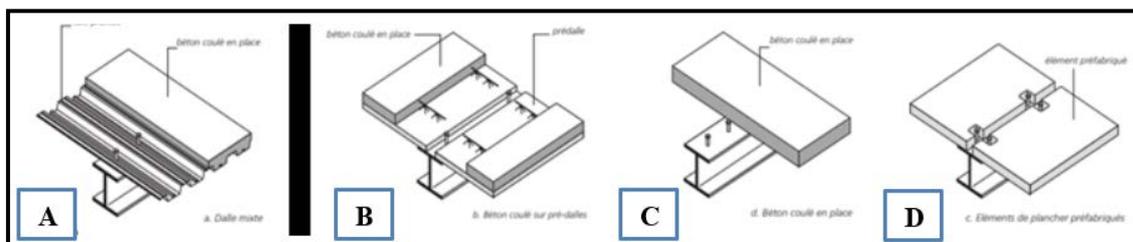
Types de dalles pour les poutres mixtes.<sup>291</sup>
